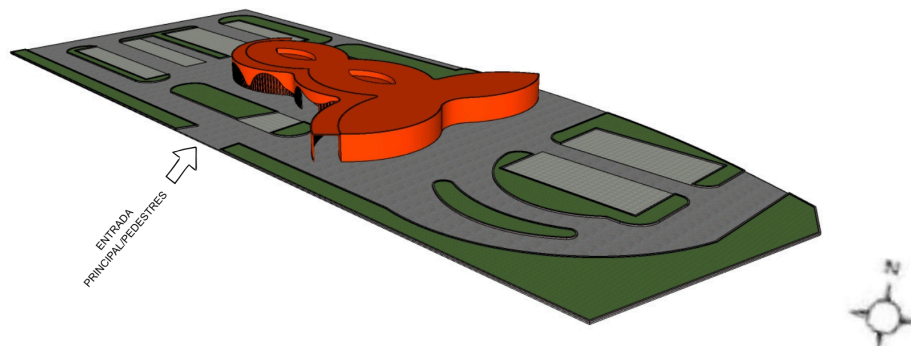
PLANO DE MASSA/VOLUMETRIA
